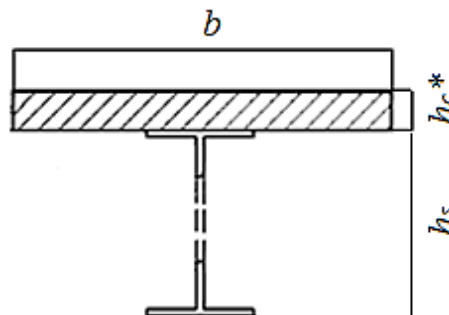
Поперечний переріз СТЗБ фрагмента з наведеною з/б плитою
